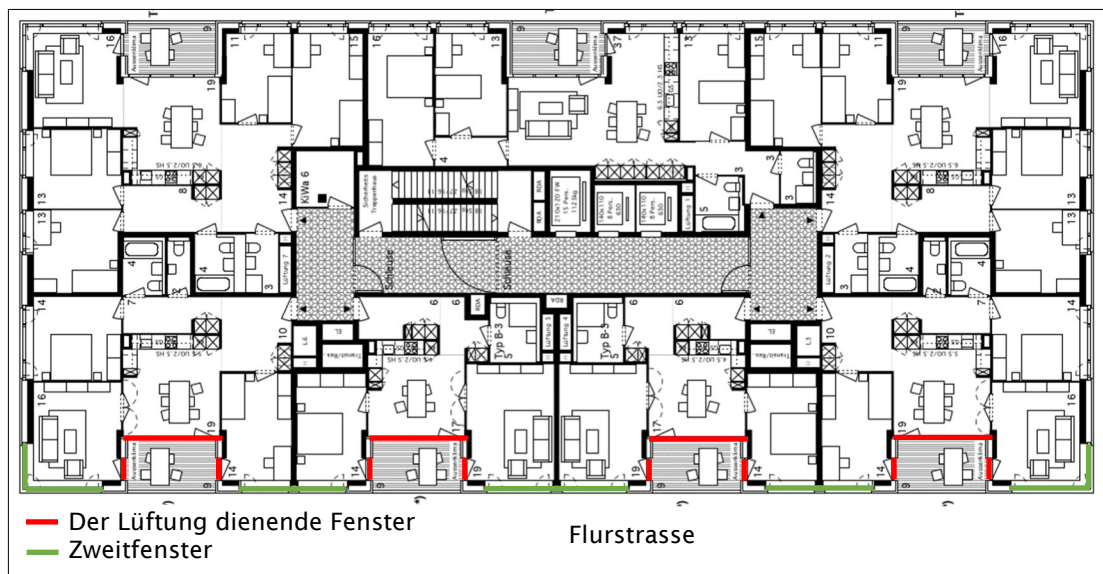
Grundriss 2.-6.OG Hochhaus Teilgebiet B, Stand März 2020
